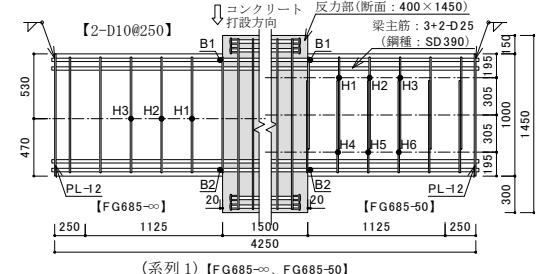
代表的試験体の形状寸法および配筋 (寸法単位: mm)
